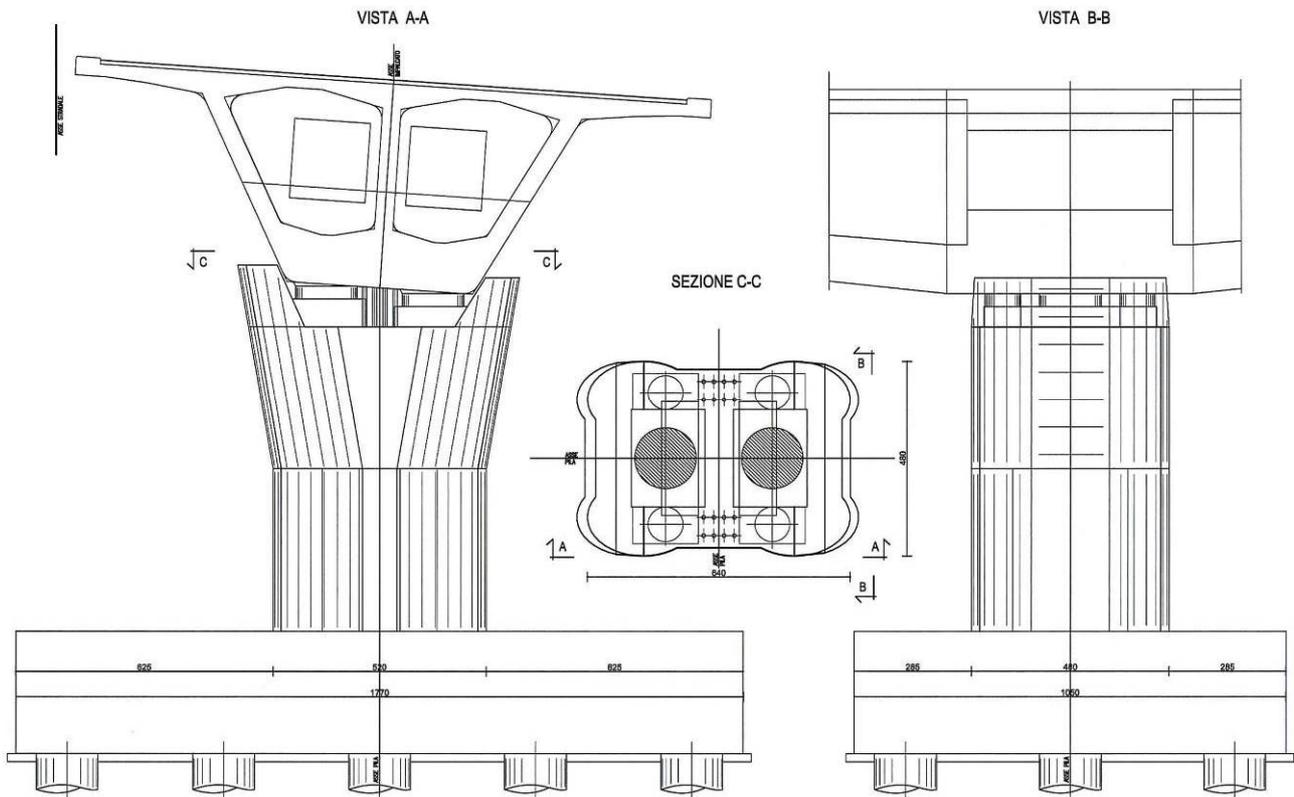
Sezioni trasversali e longitudinali degli impalcati su pila e pianta del pulvino - Progetto Definitivo.
